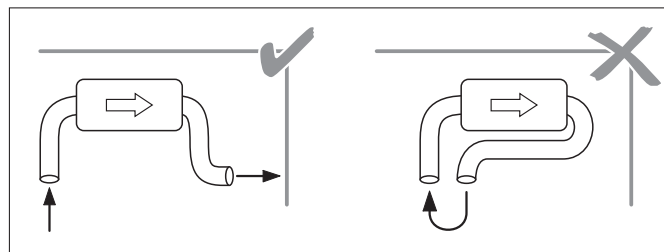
Не допускайте перетекания нагретого воздуха от его выхода ко входу холодного воздуха
